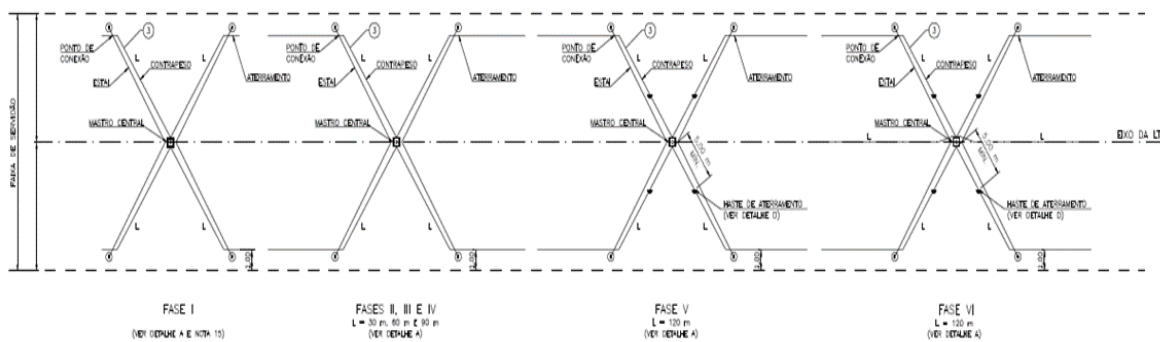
Esquema de aterramento de estruturas estaiadas em 6 fases.
